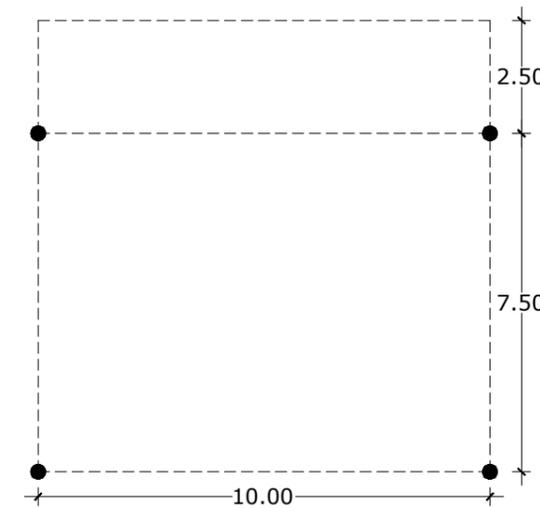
Grilla estructural bloque 1, 2, 3 y 4
